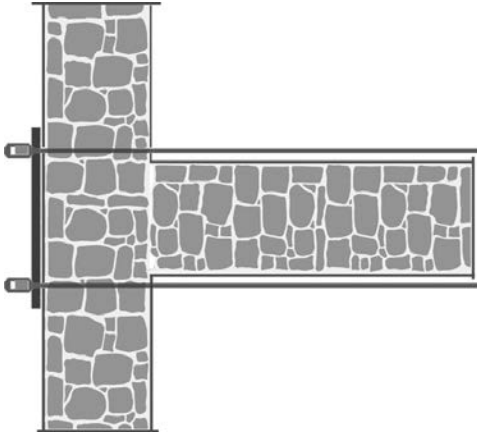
Vista in pianta di catena binata aderente al muro trasversale a livello del solaio.
